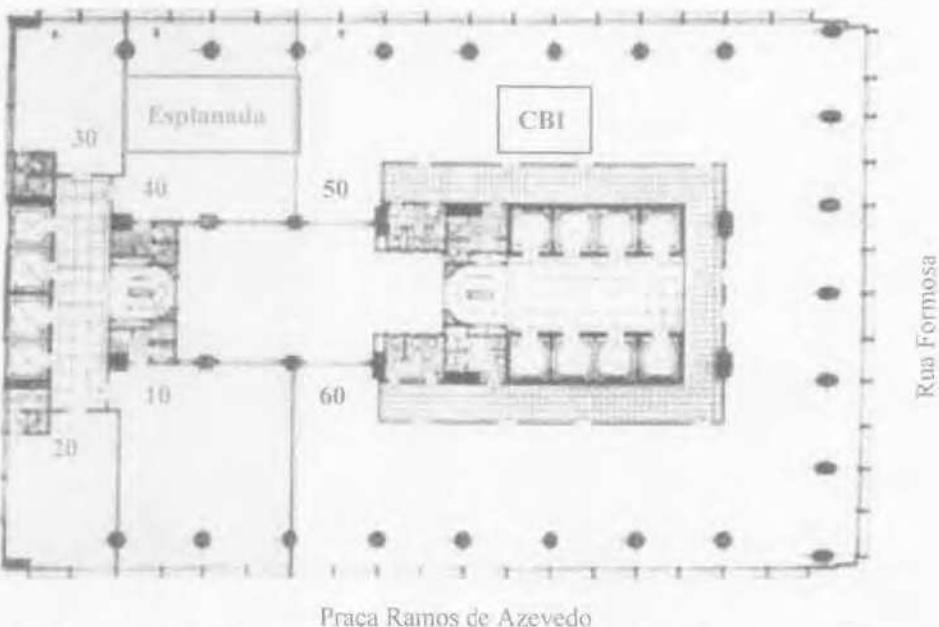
Imagem da planta do pavimento tipo do Edifício CBI-Esplanada. (Fonte: <http://www.cbiesplanada.com.br/historico.htm>)
